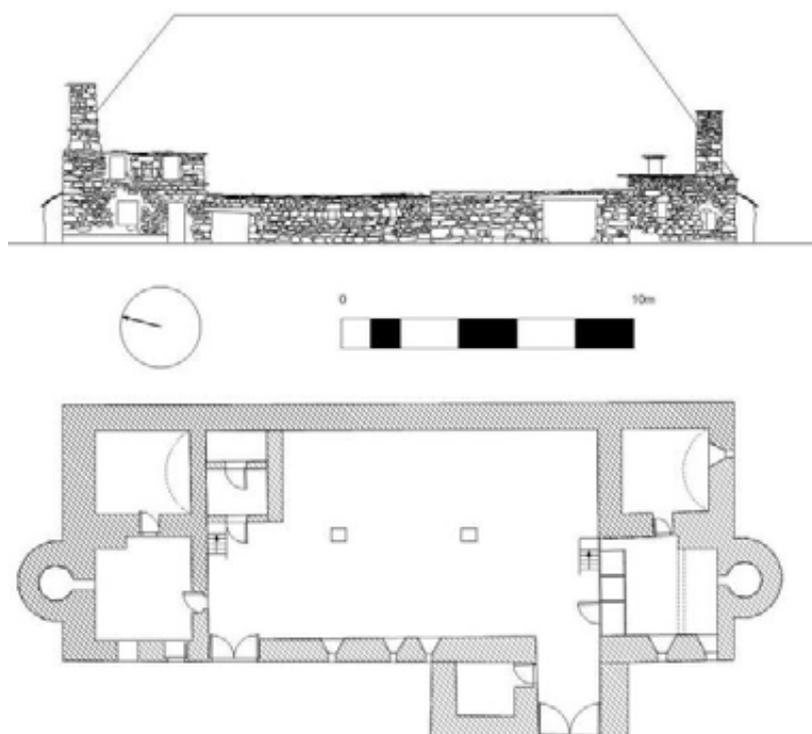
Plan et relevé pierre à pierre de la ferme Philip
